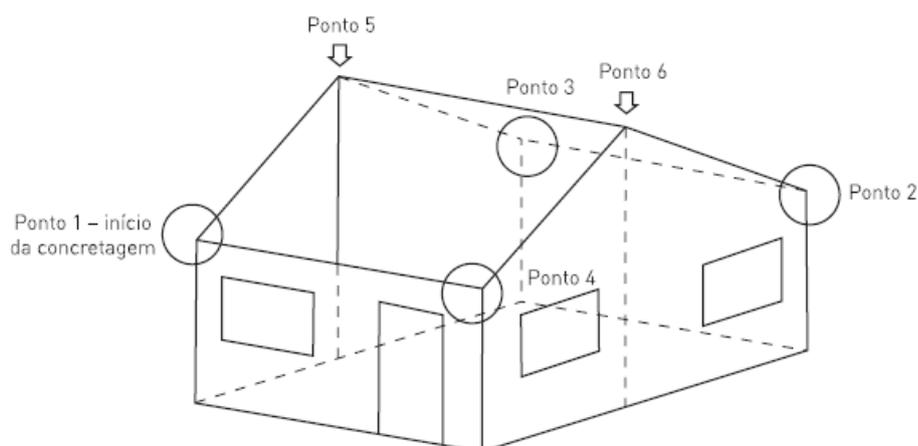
Exemplo de plano de concretagem para edificações térreas.
